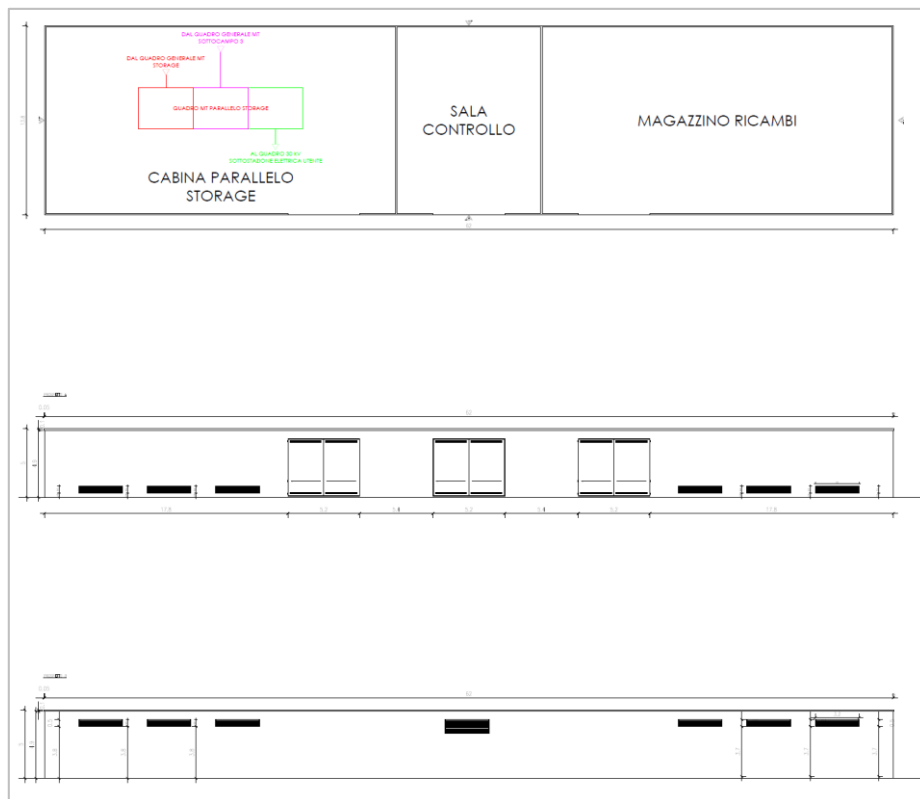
pianta e prospetti della cabina parallelo storage – sala controllo – magazzino ricambi
